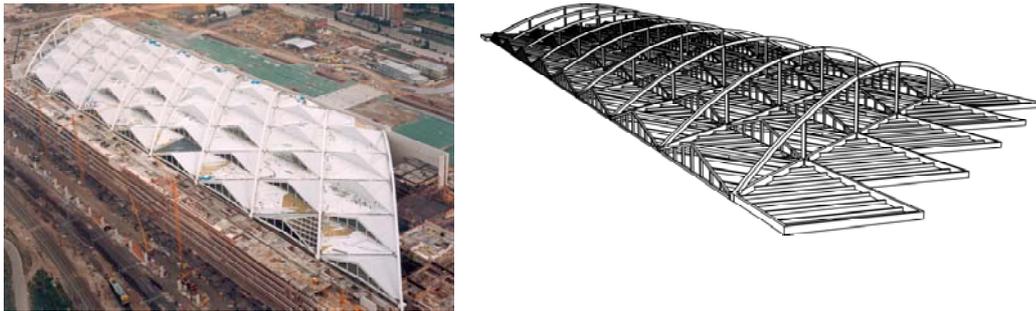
Vista aérea de la cubierta de la estación y representación esquemática de la estructura.
